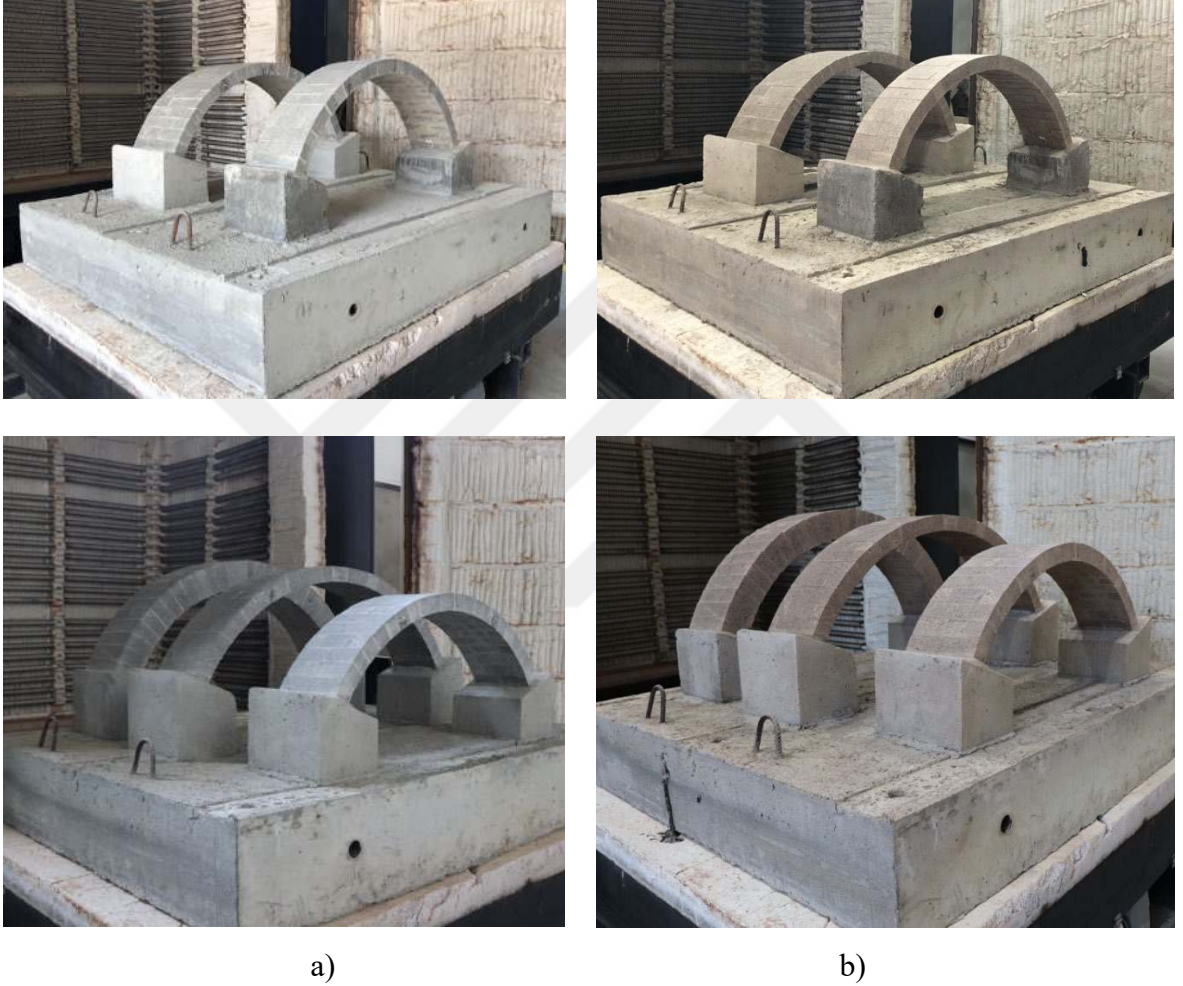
Kemer modellerinin yüksek sıcaklık test fırınına taşınması
